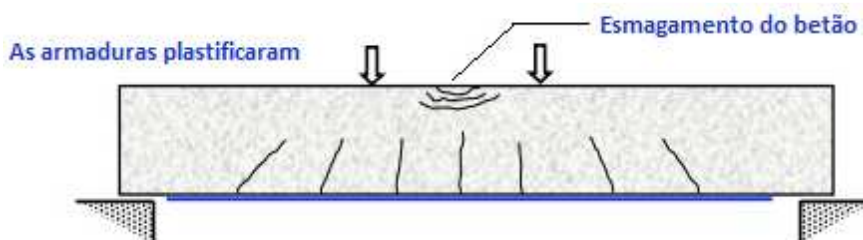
Esmagamento do betão após plastificação das armaduras [adaptado de 52]
